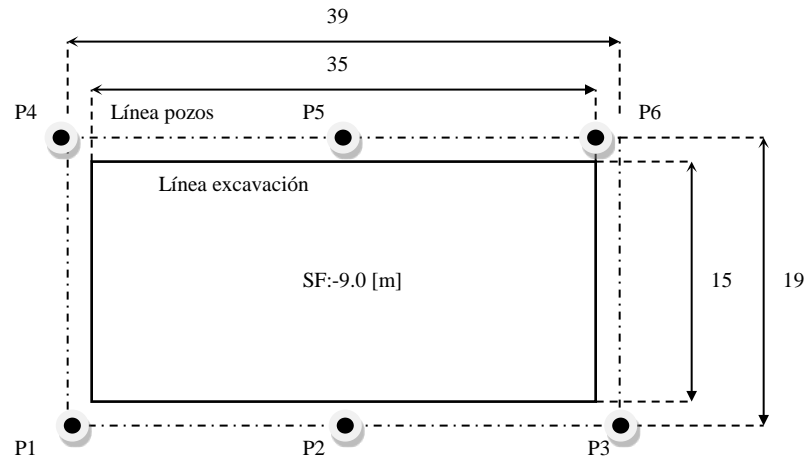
Disposición de Pozos en el perímetro de la excavación.
